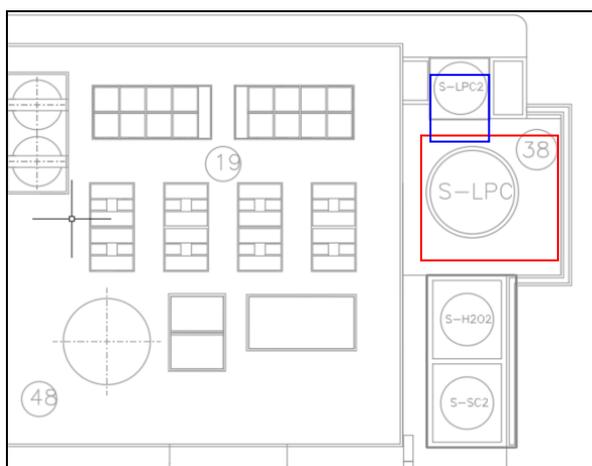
Stralcio planimetria generale con indicazione (in rosso) dell'attuale zona di stoccaggio della calce idrata (38) e del silo aggiuntivo che si propone di installare (in blu).
